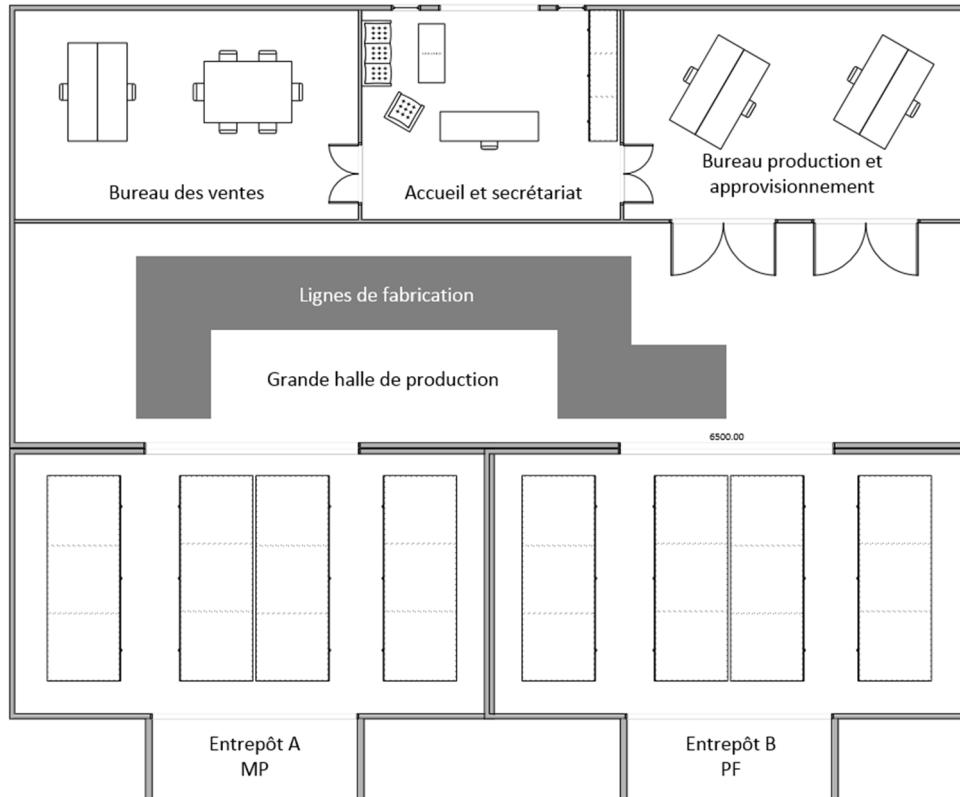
Plan d'aménagement du site de production Brewery & Co.
